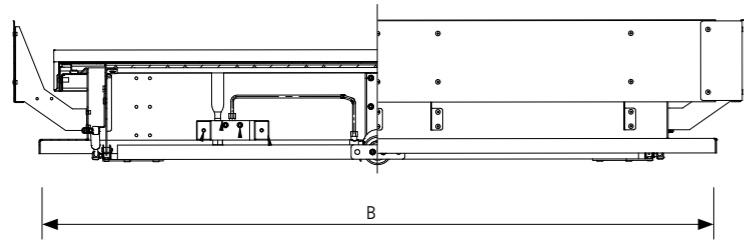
Schnitt B-B durch einen Lamellenlüfter mcr LAM in geschlossener Position (Dacheinbau)
